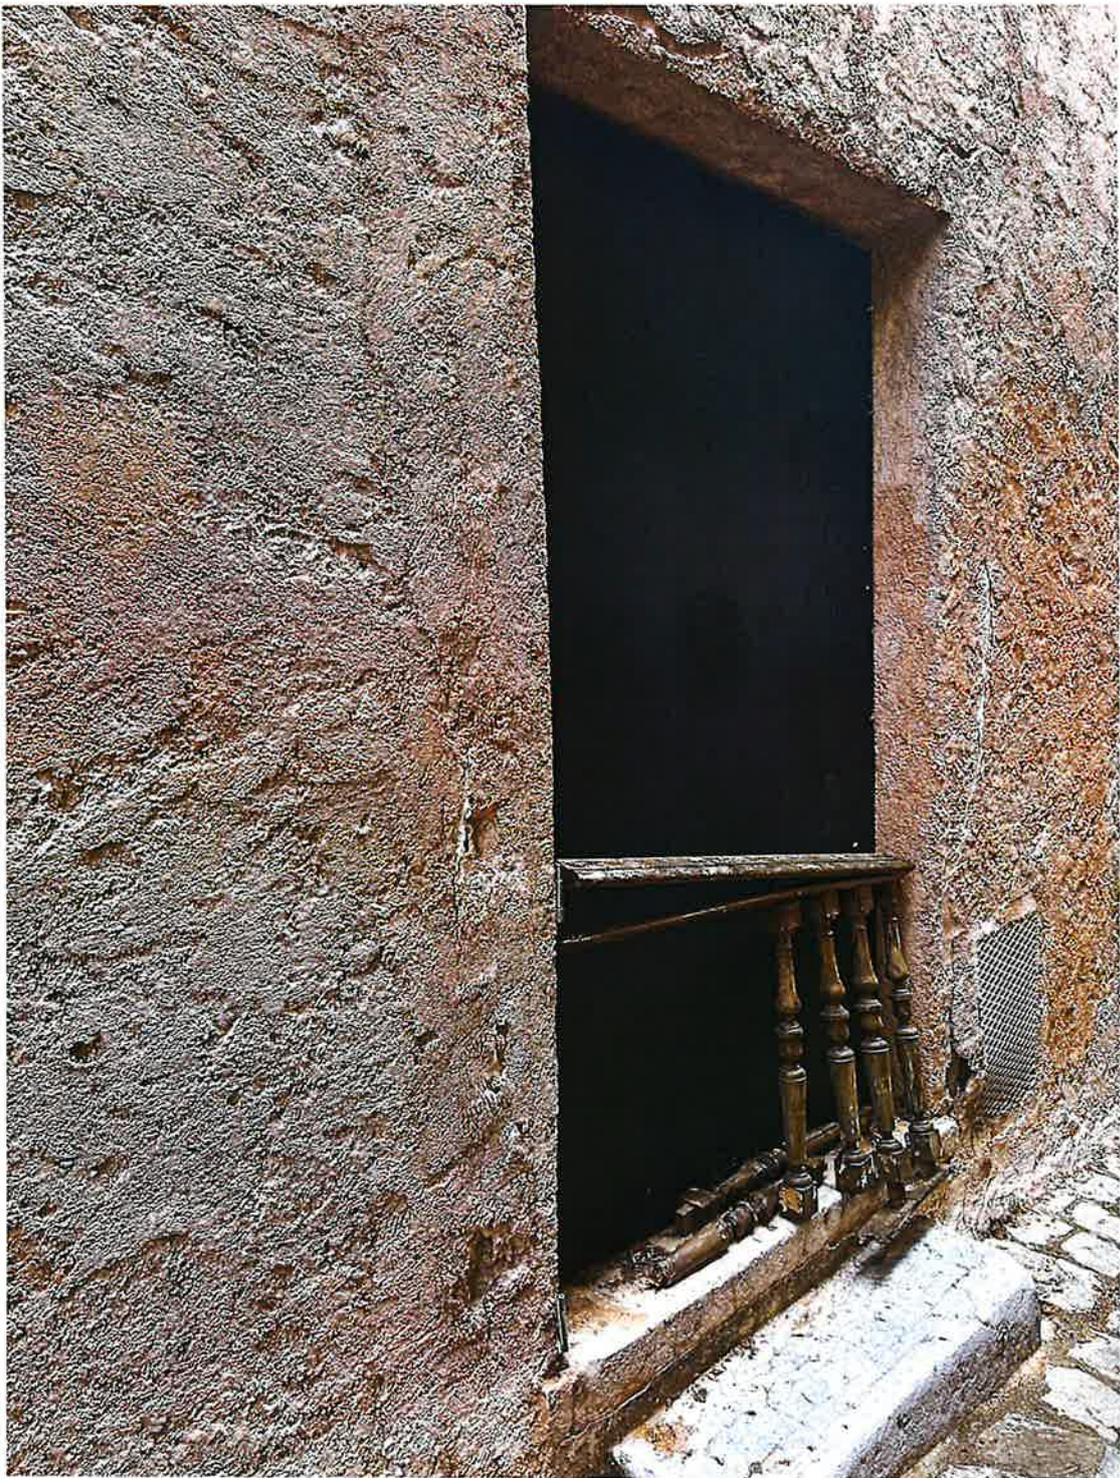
photo de l'extérieur porte d'entrée condamnée en date du 27/06/2025
